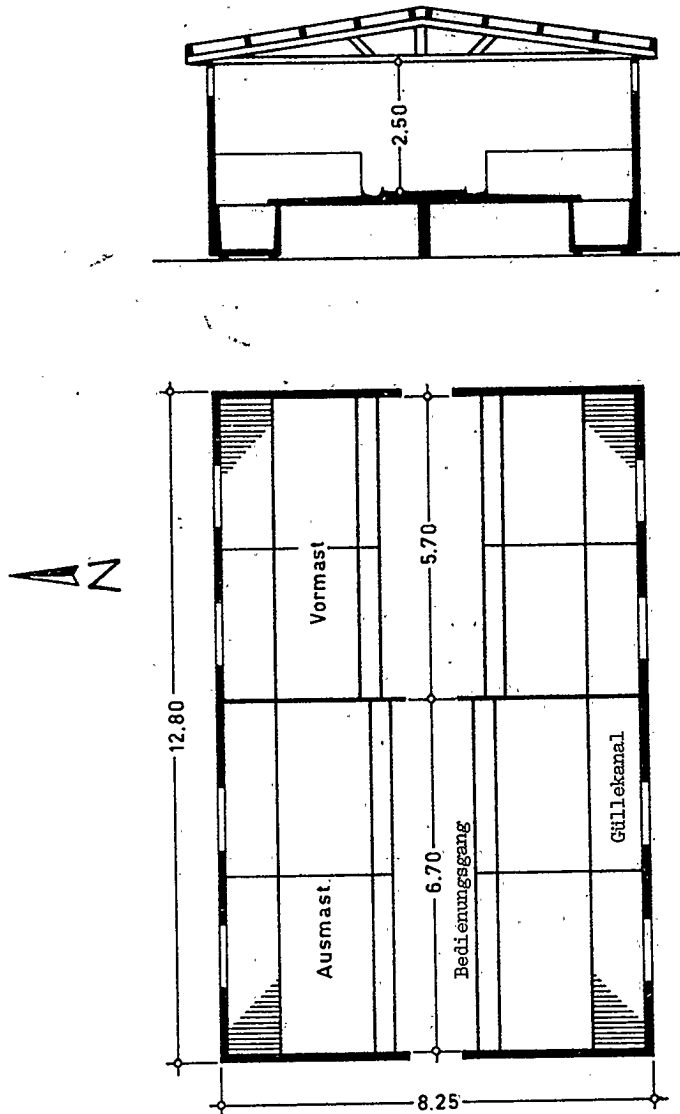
Der Referenzstall, Grundriss und Schnitt.
